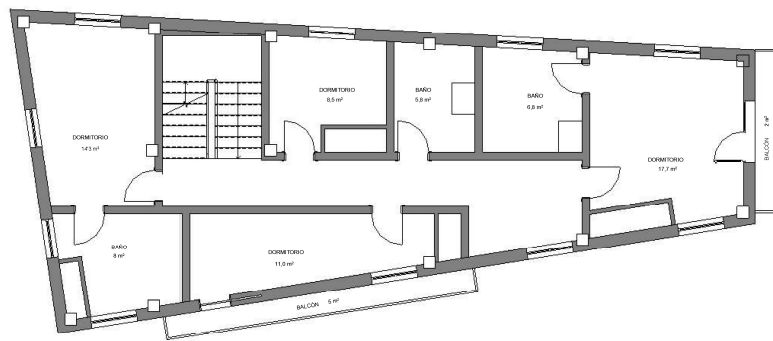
Esquema de la promoción: Planta tipo. Elaboración propia.
